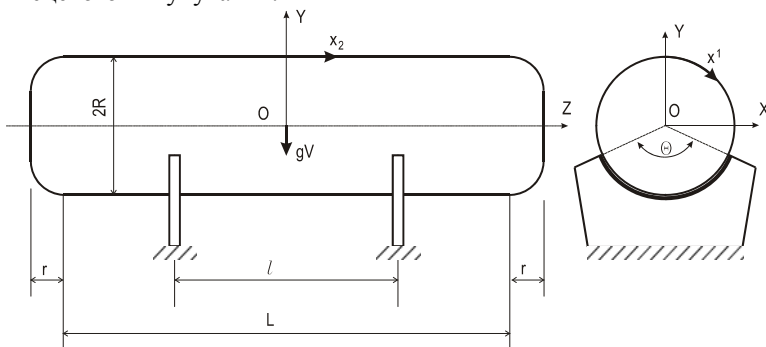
Розрахункова схема горизонтального циліндричного резервуара з еліптичними кришками
